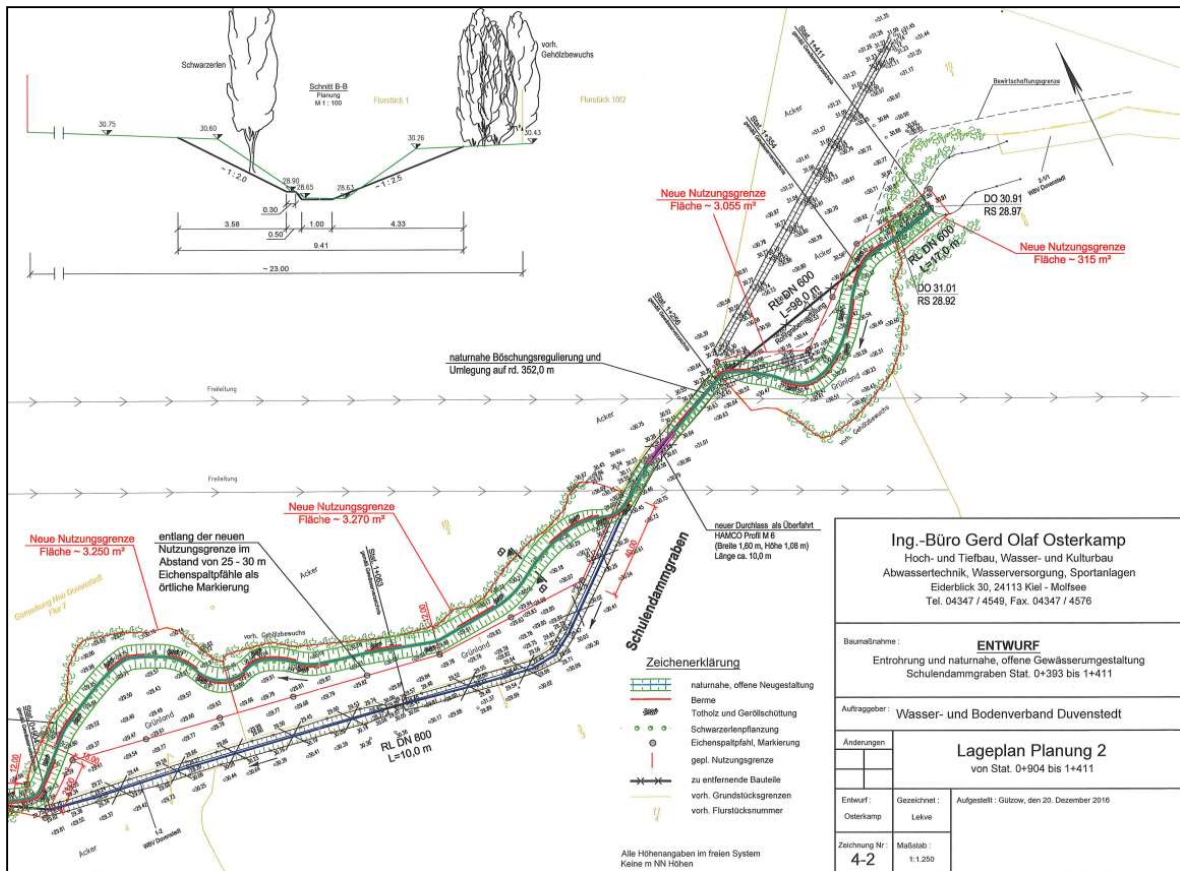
Renaturierung Schulendammgraben - Lageplan
